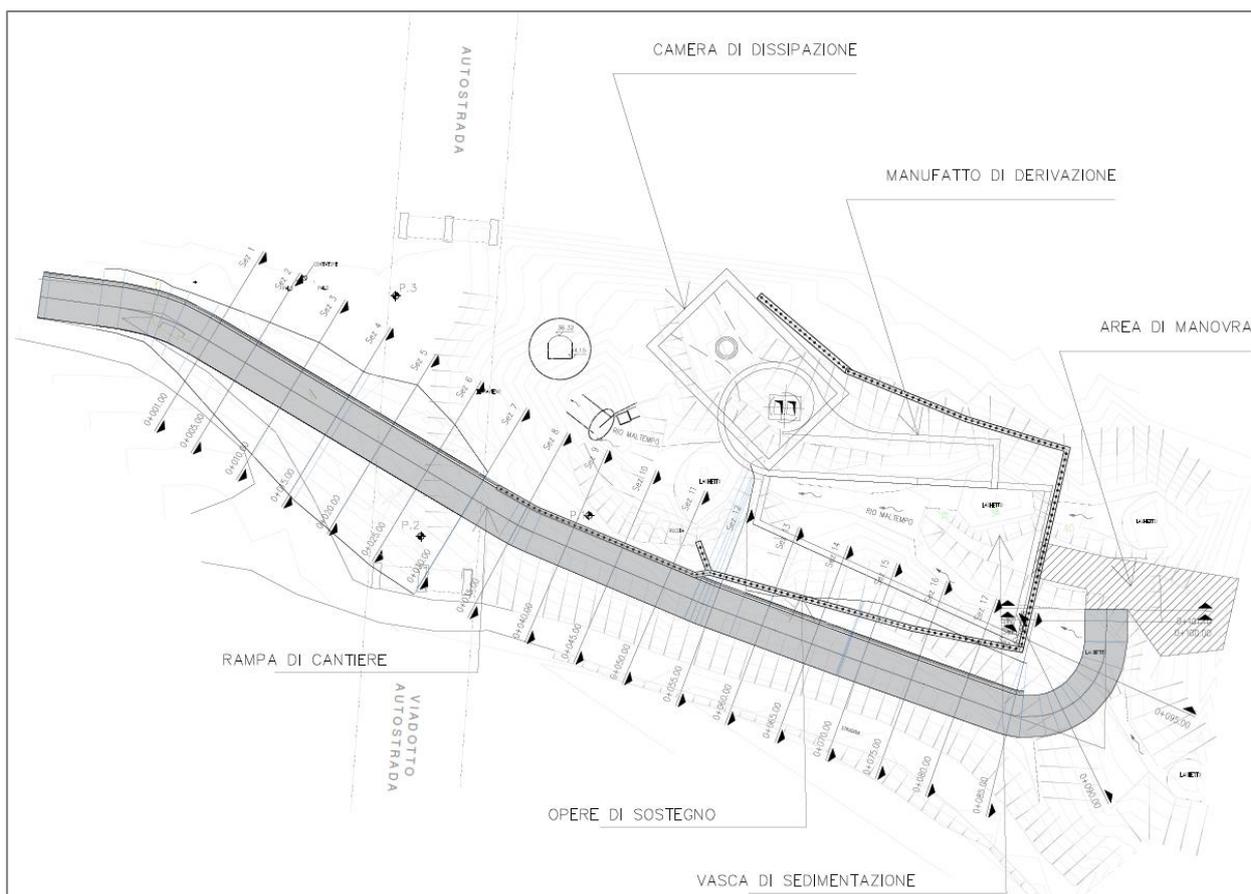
Estratto della planimetria generale della rampa di accesso all'opera di presa
